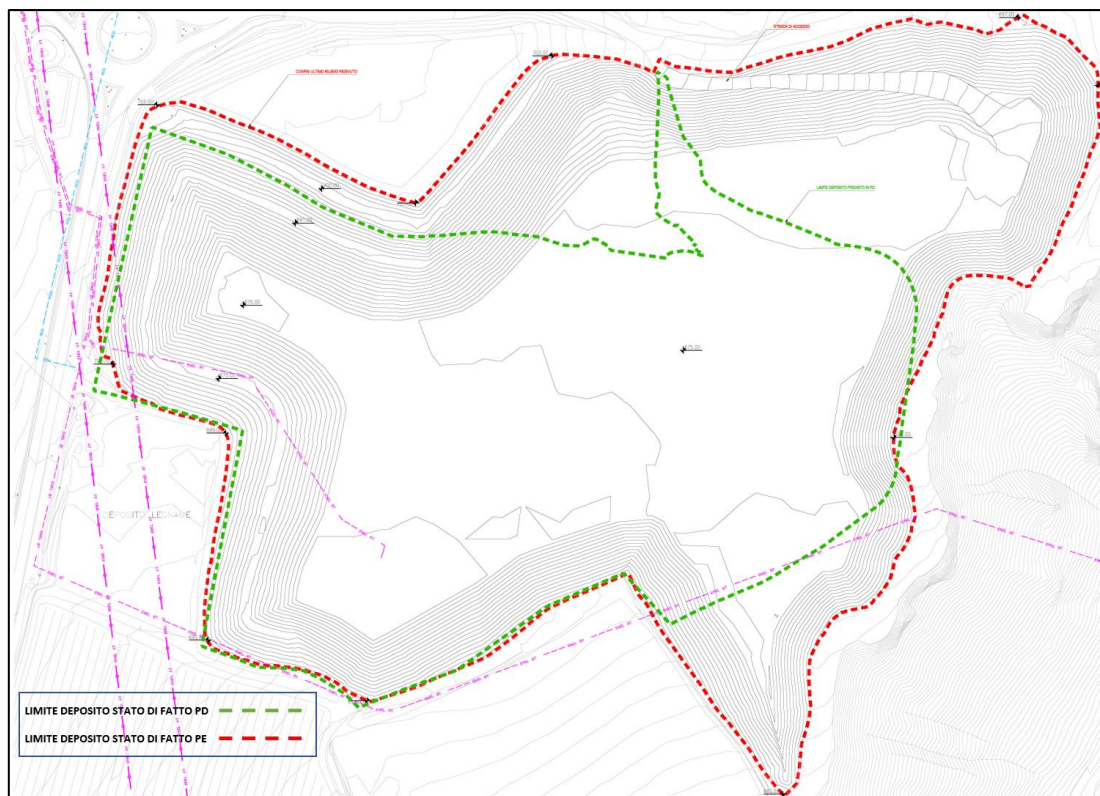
Planimetria Stato di fatto con confronto PD-PE – Forch I
